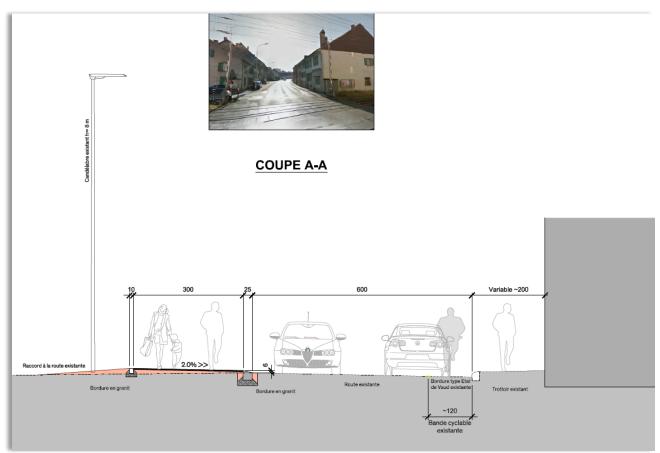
Coupe A sur raccordement rue du Favez - Vignette
